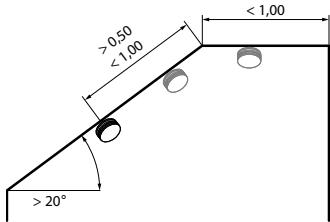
Gerade Montagefläche weniger als 1 m lang und 1 m breit
